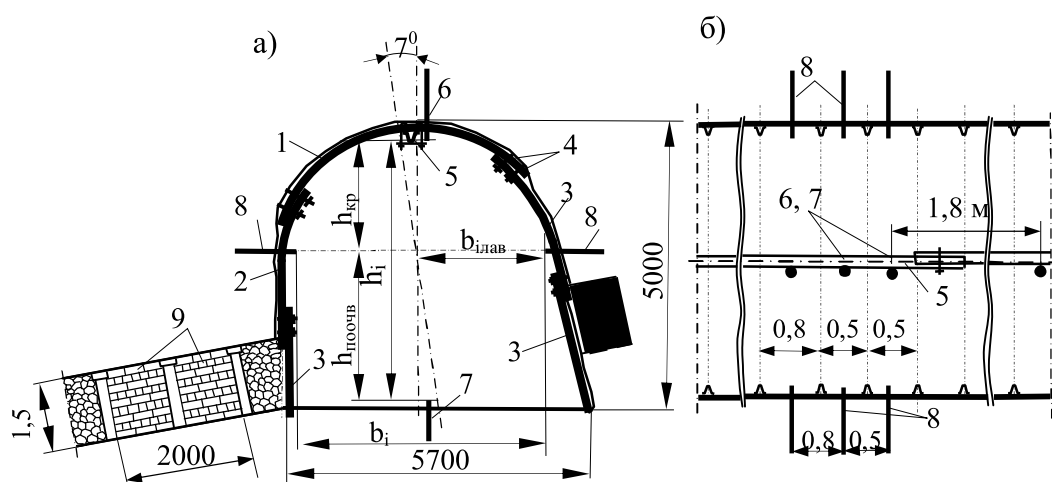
Схема расположения контурной замерной станции в вентиляционном штреке 11-й восточной лавы пласта k_3 в разрезе (а) и плане (б) выработки при расположении одной балки из СВП-27 по периметру овоидной крепи: 1 – верхняя часть крепи; 2, 3 – соответственно вертикальная и наклонная стойки крепи; 4 – замки крепи; 5 – продольная балка крепи усиления; 6, 7 – соответственно верхний и нижний контурные реперы; 8 – боковые реперы; 9 – жесткая опорная полоса из породных полублоков на бровке лавы
